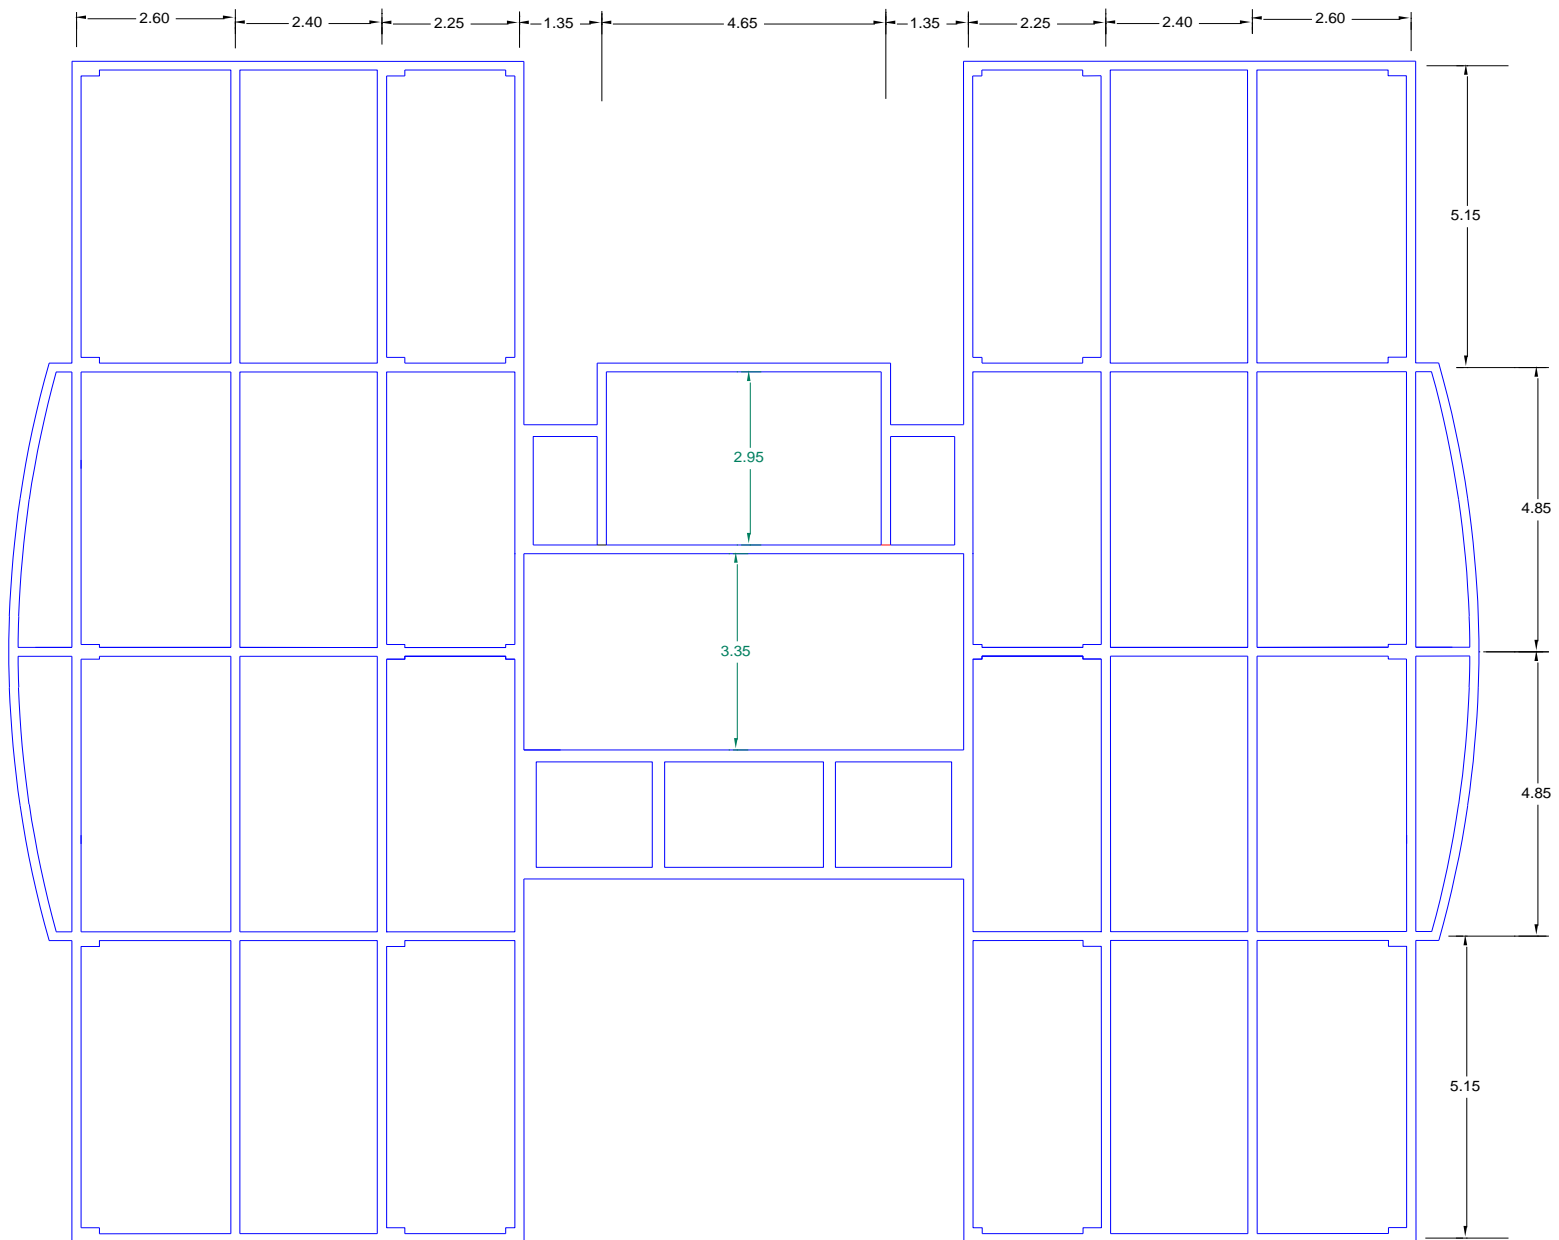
, planta de vigas de carga (diseño de elaboración propia)
